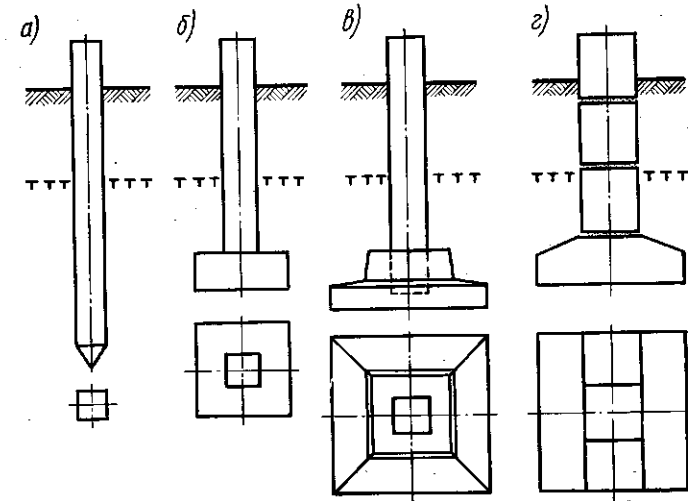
Основные типы фундаментов зданий, возводимых на вечномерзлых грунтах:
